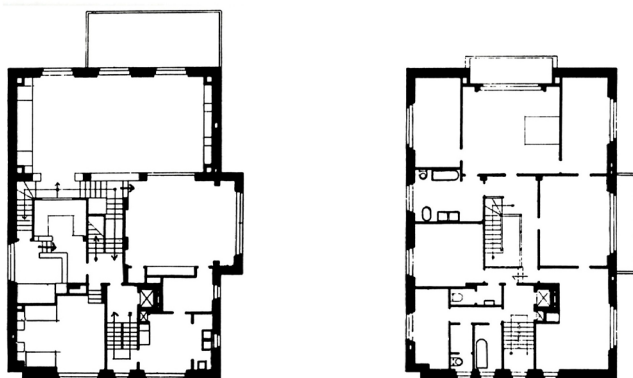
Villa Müller. Planos de la planta noble y planta noble.
